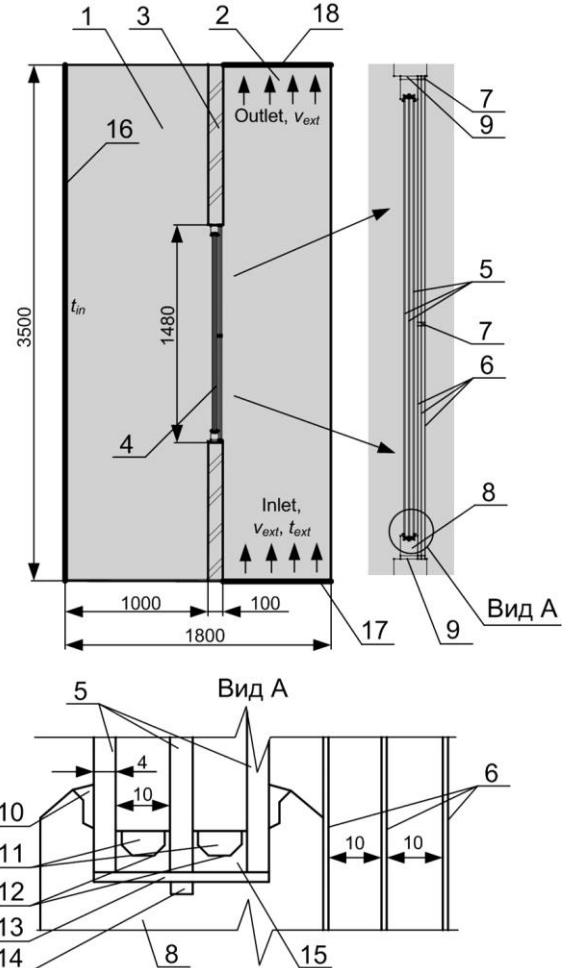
Расчетная схема модели: 1, 2 – теплое и холодное отделения климатической камеры; 3 – кирпичная перегородка; 4 – испытуемый оконный блок; 5 – стекла; 6 – металлические экраны; 7 – разделительная пластиковая планка; 8 – деревянная рама; 9 – теплоизоляция из пенополиуретана; 10 – силиконовый герметик; 11 – осушитель; 12 – дистанционная рамка; 13 – пластиковая проставка; 14 – паз для вентиляции; 15 – герметик; 16 – «теплая» стена; 17, 18 – подача и отвод воздуха
